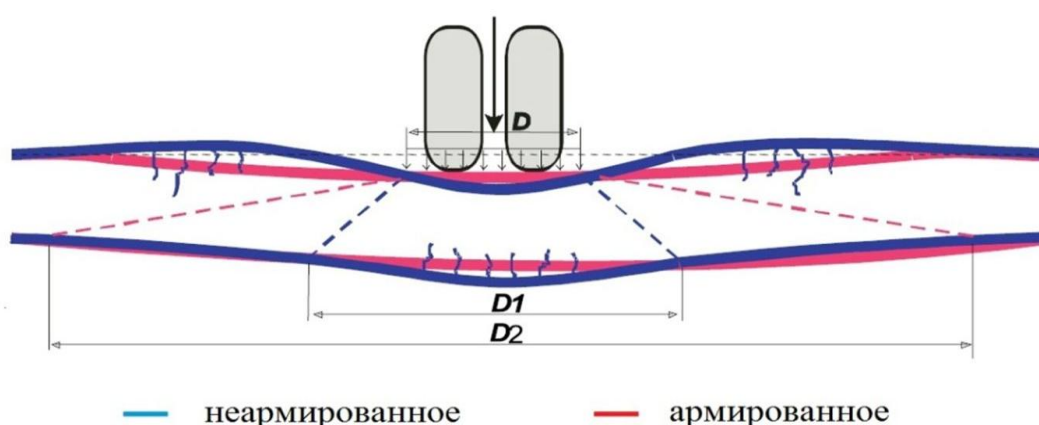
Асфальтобетонное покрытие под колесной нагрузкой
